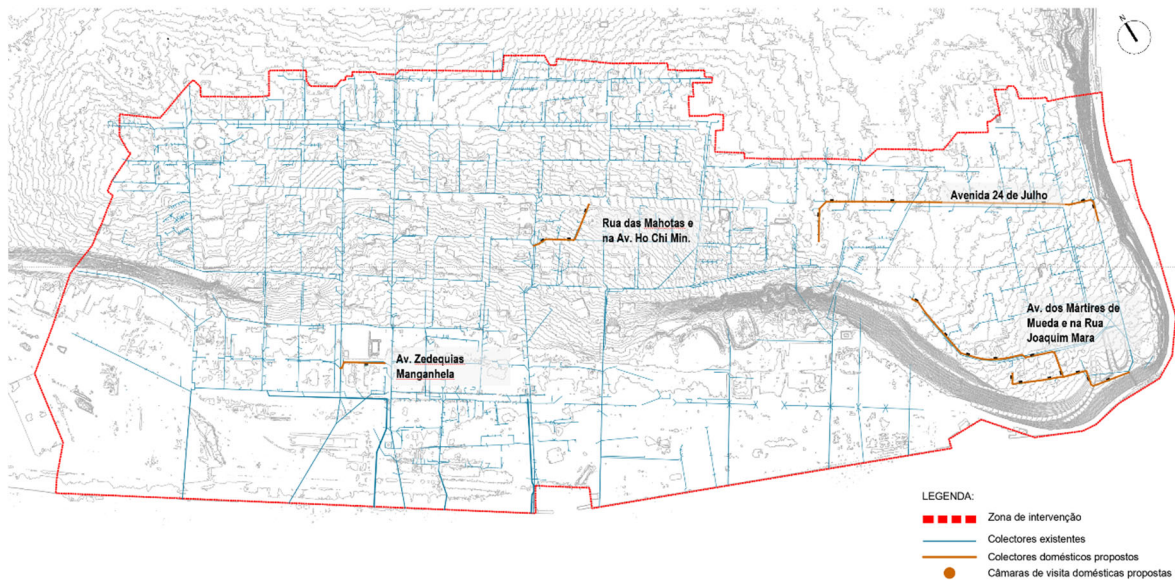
Planta esquemática ilustrativa do traçado dos colectores domésticos a serem reforçados
